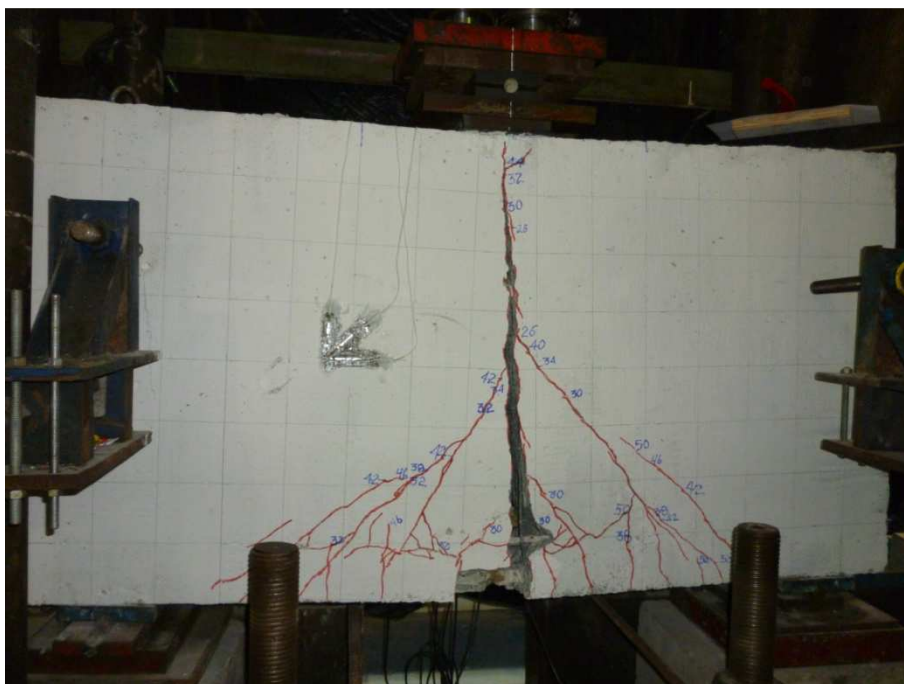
Configuração de fissuras - Viga V2-2.
